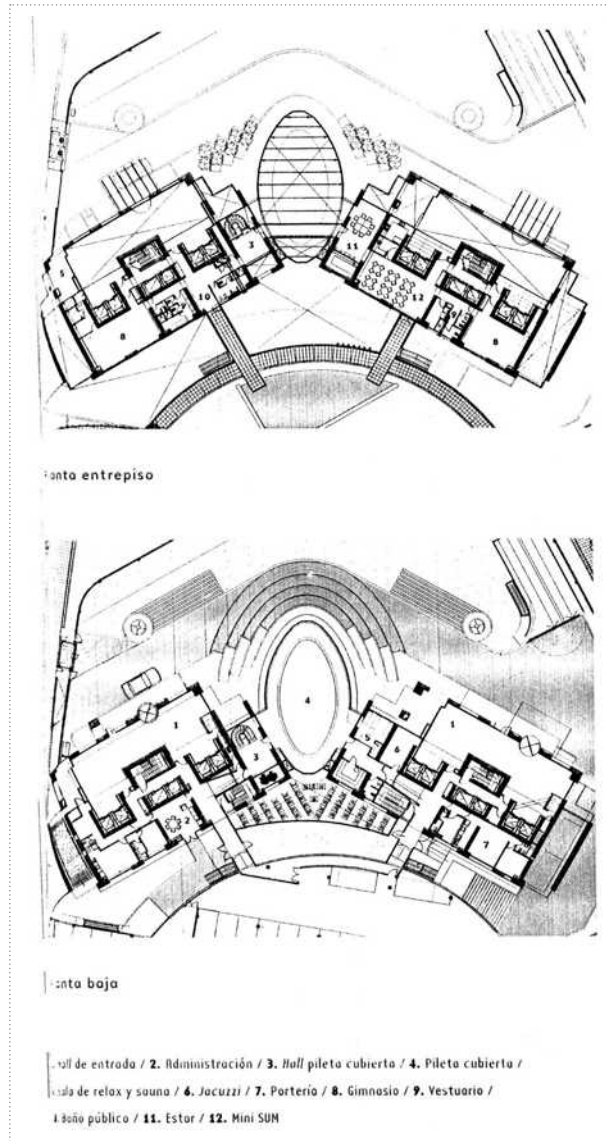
Planta do pavimento térreo e do mezanino (de baixo para cima).
